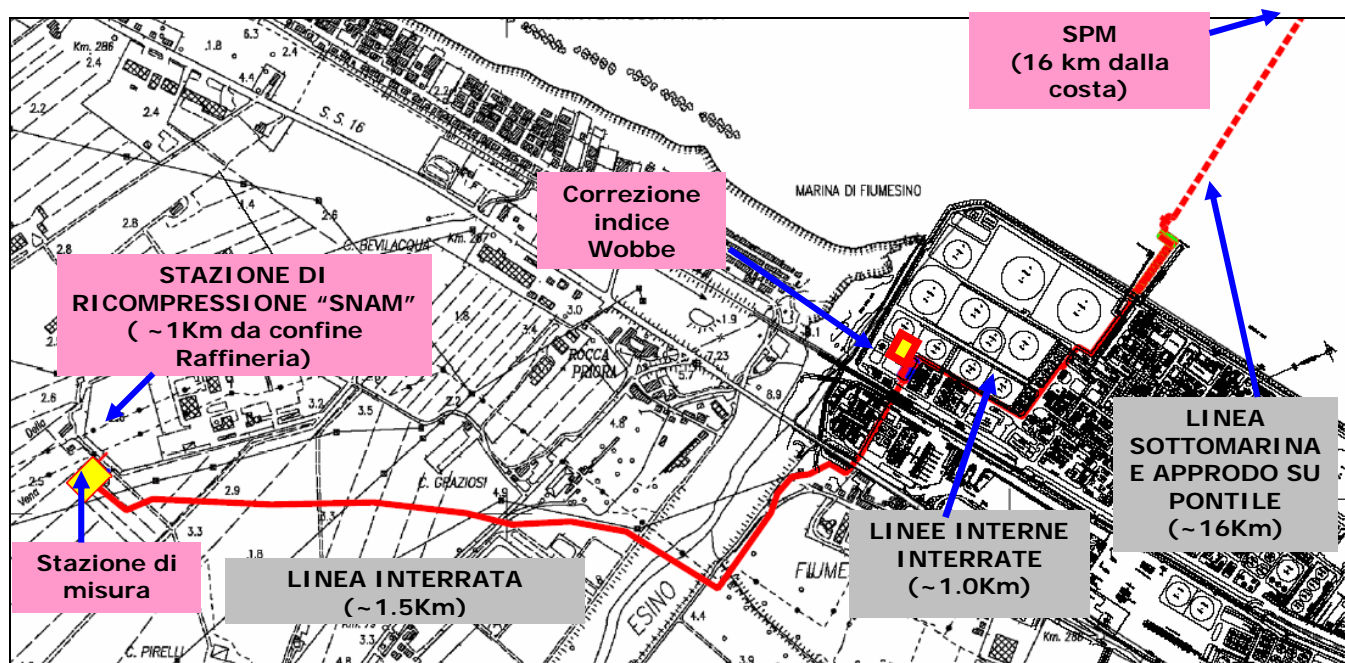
/1 - Layout preliminare nuovo gasdotto di collegamento SPM-Stazione SNAM
